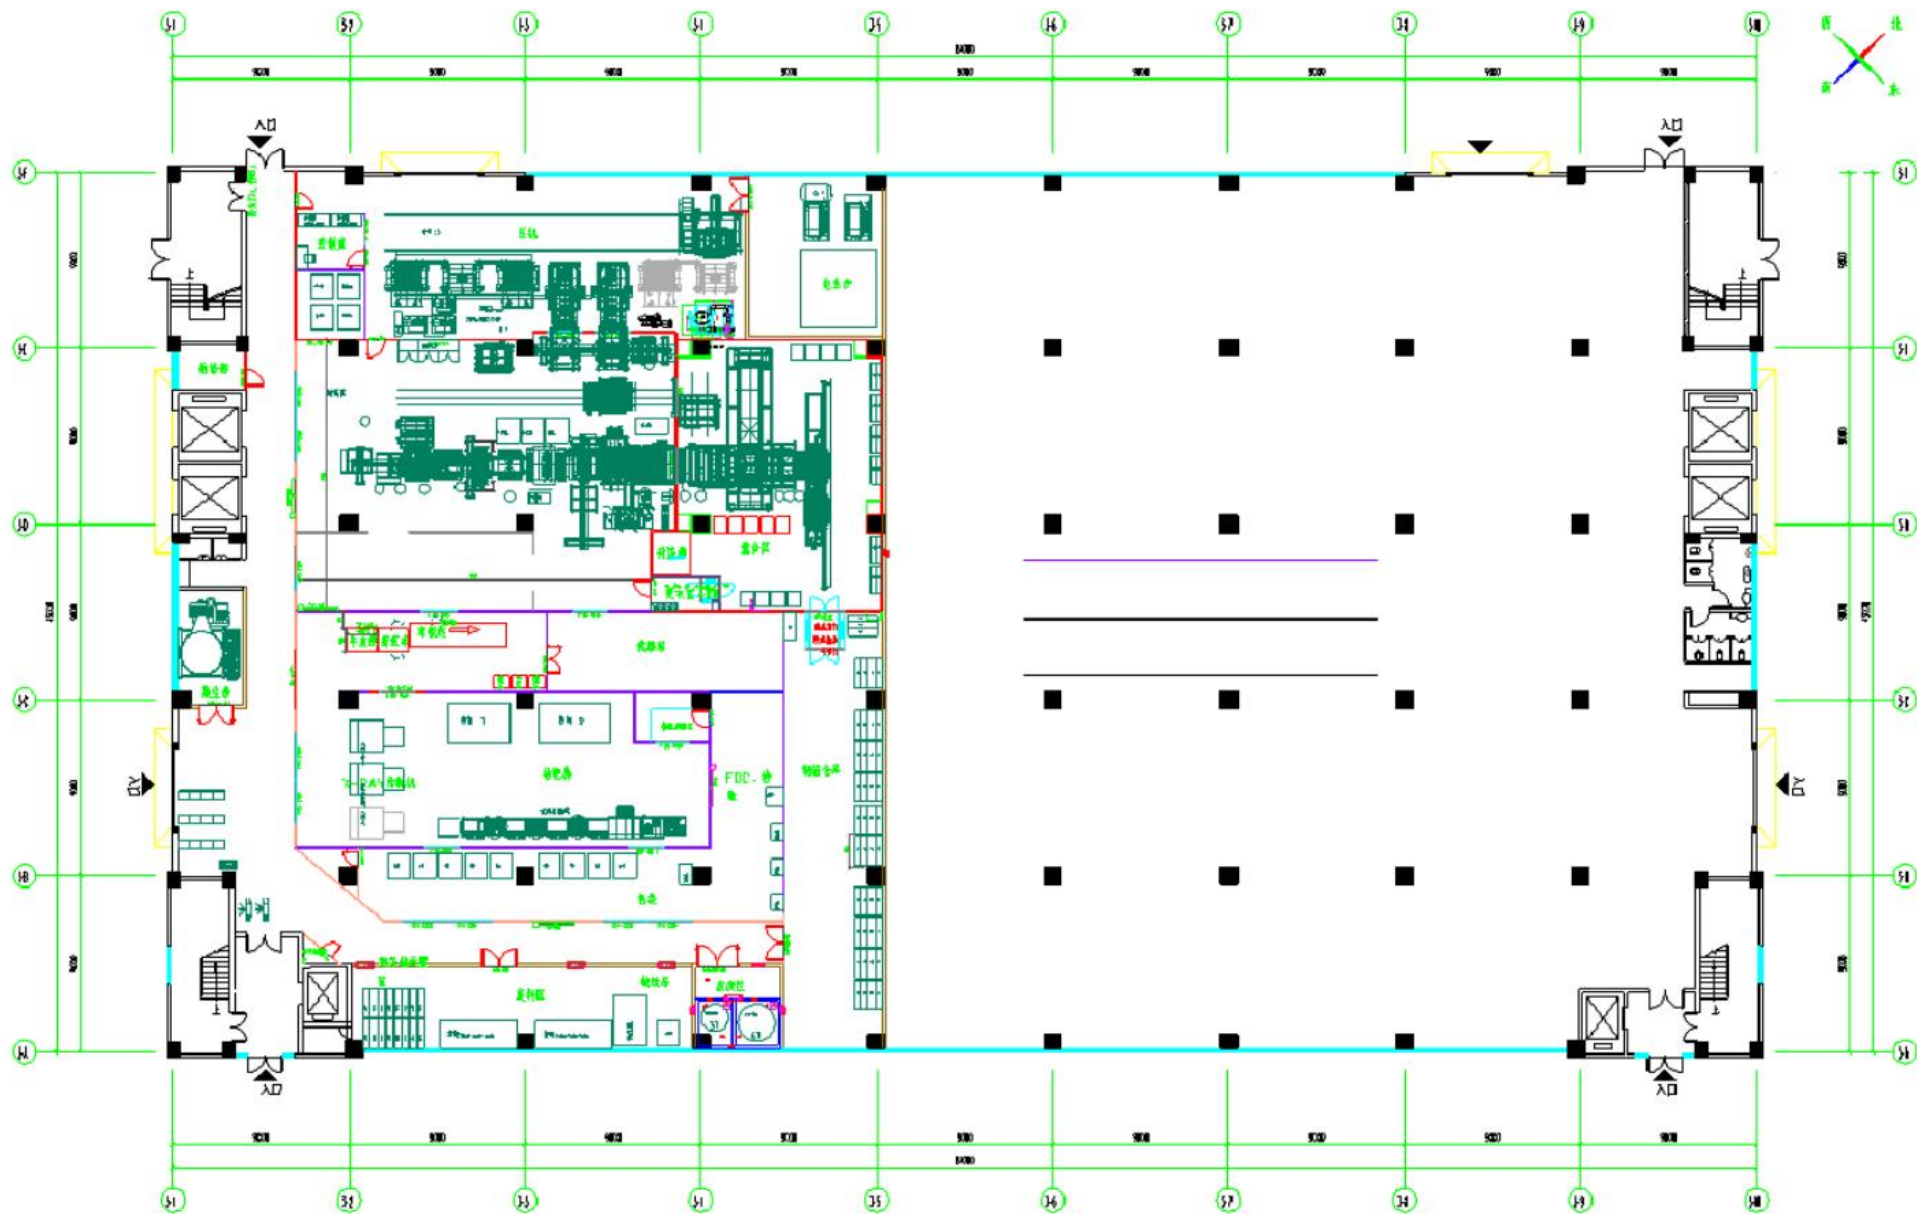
本项目三号厂房 1 楼左区实际平面布置图
